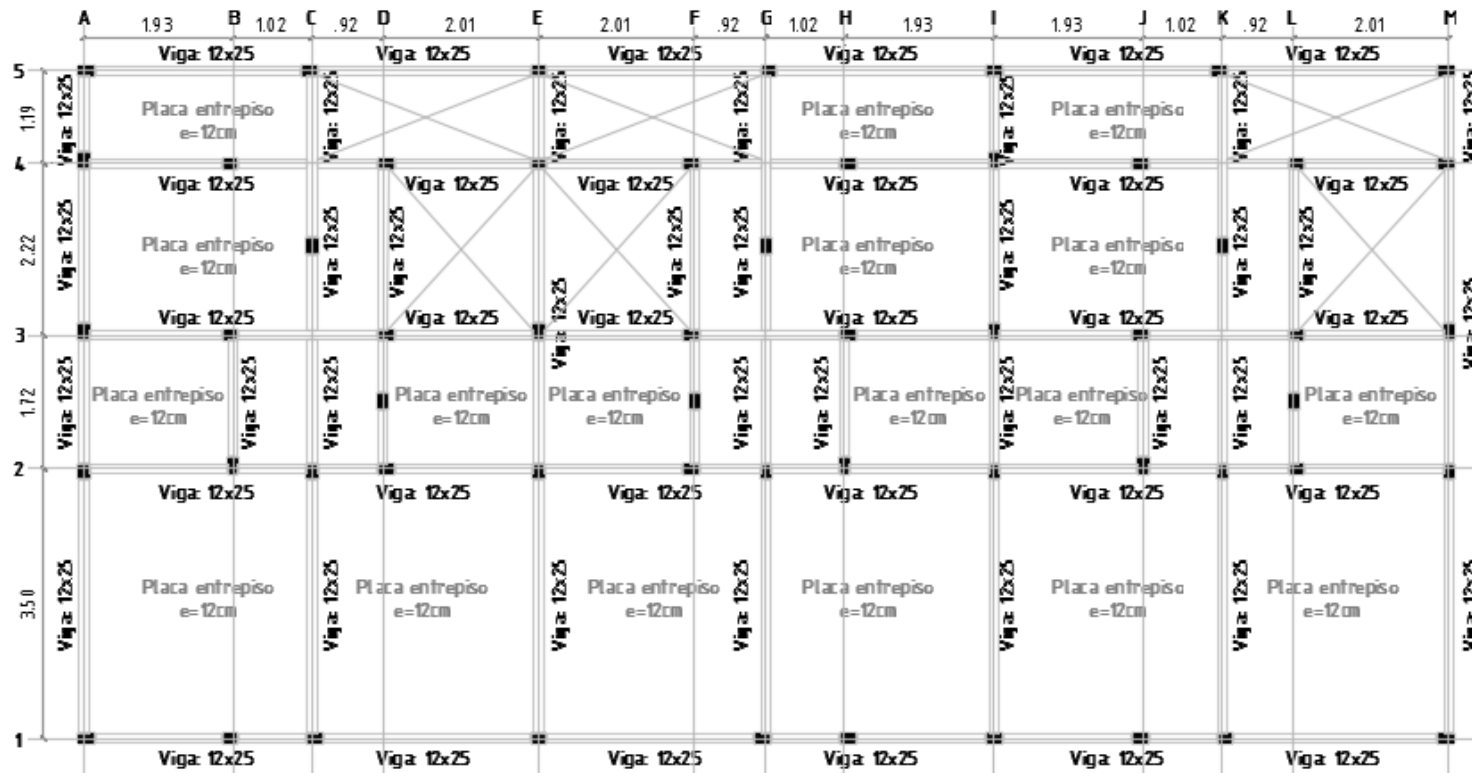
Configuración en planta de vigas de amarre a nivel de entrepiso
